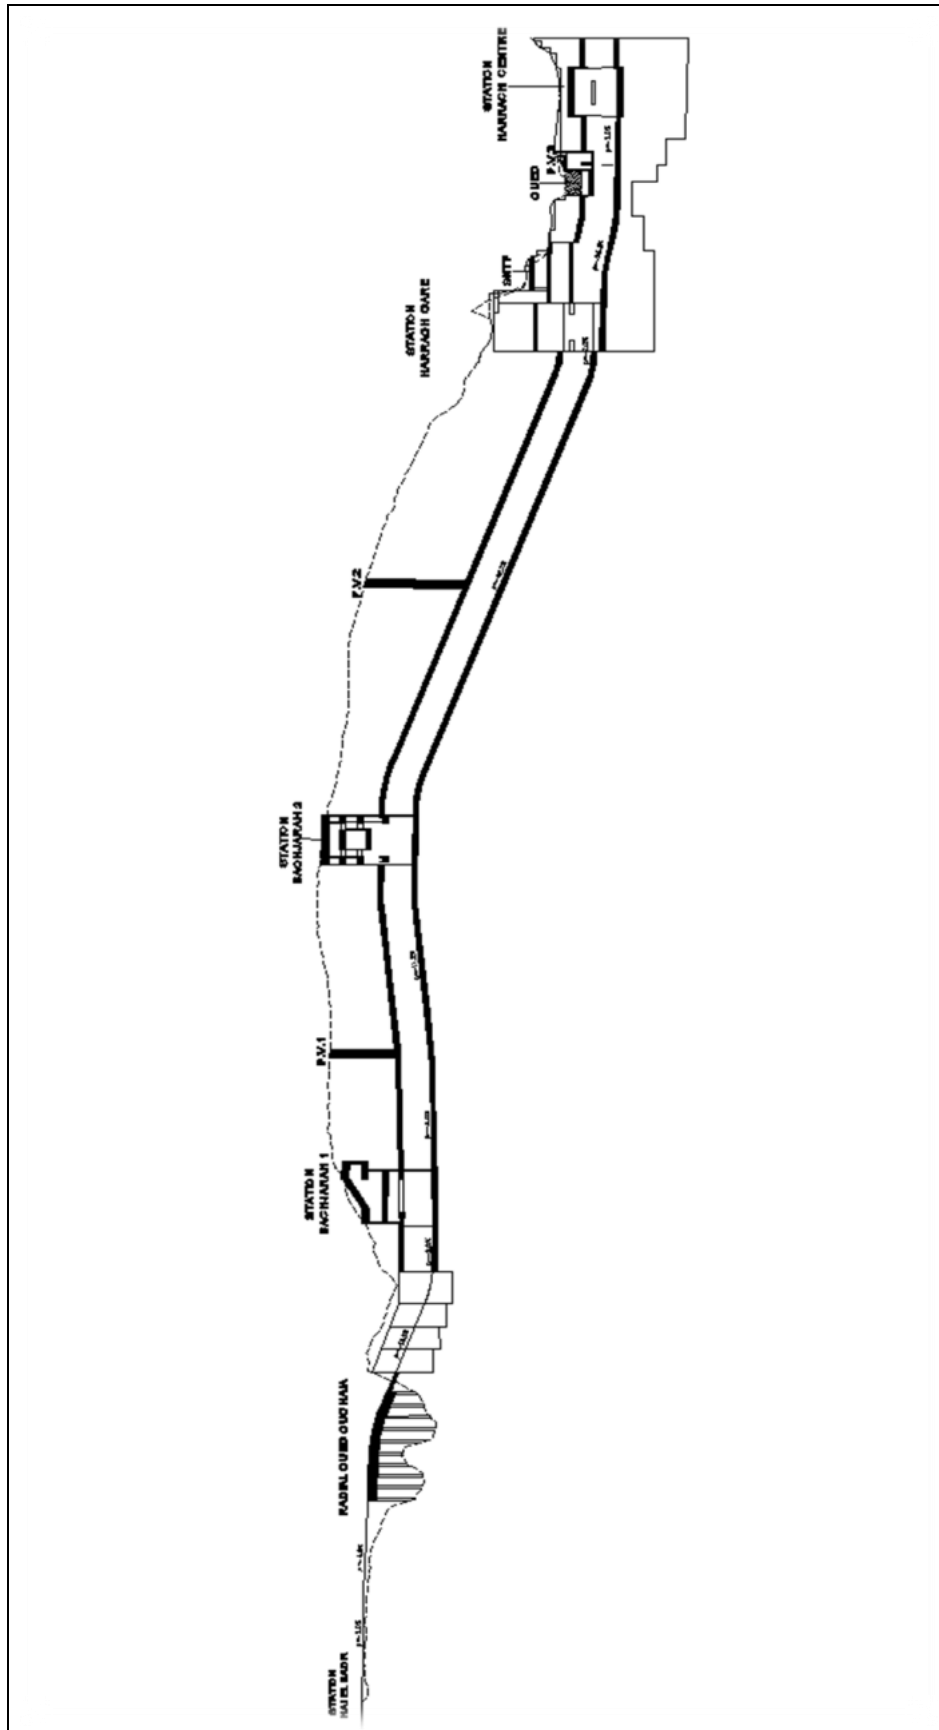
plan de l'extension B : HAI EL BADR –EL HARRACH
